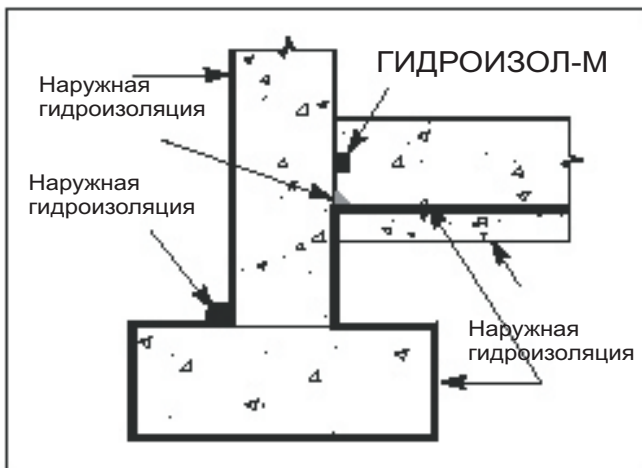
Монтаж шнура на лифтовых приямках без наружной гидроизоляции оголовка
